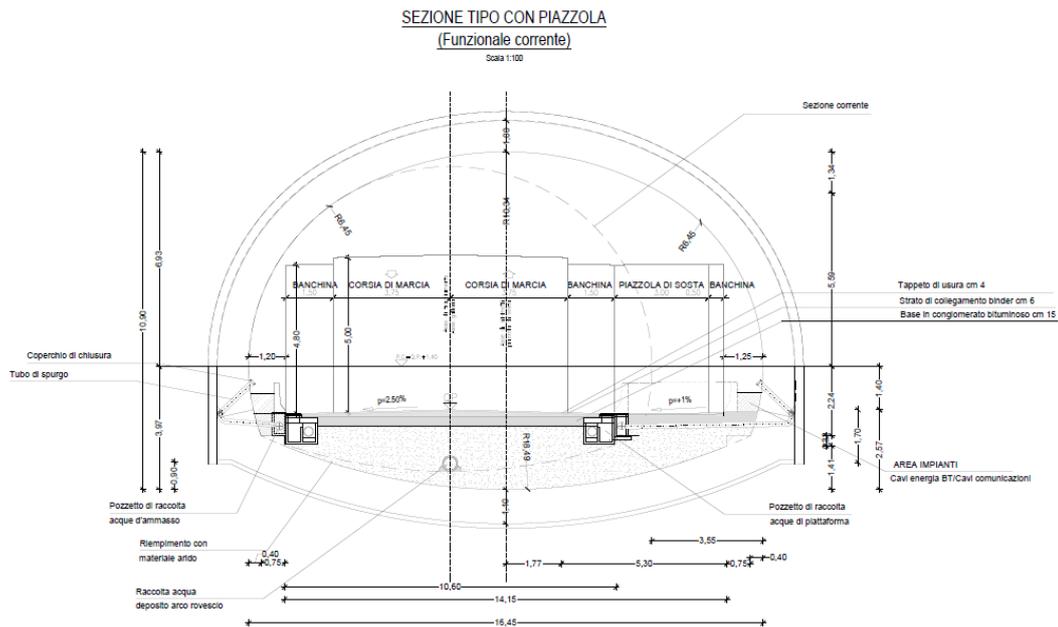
Galleria naturale, sezione tipo piazzola di sosta.
